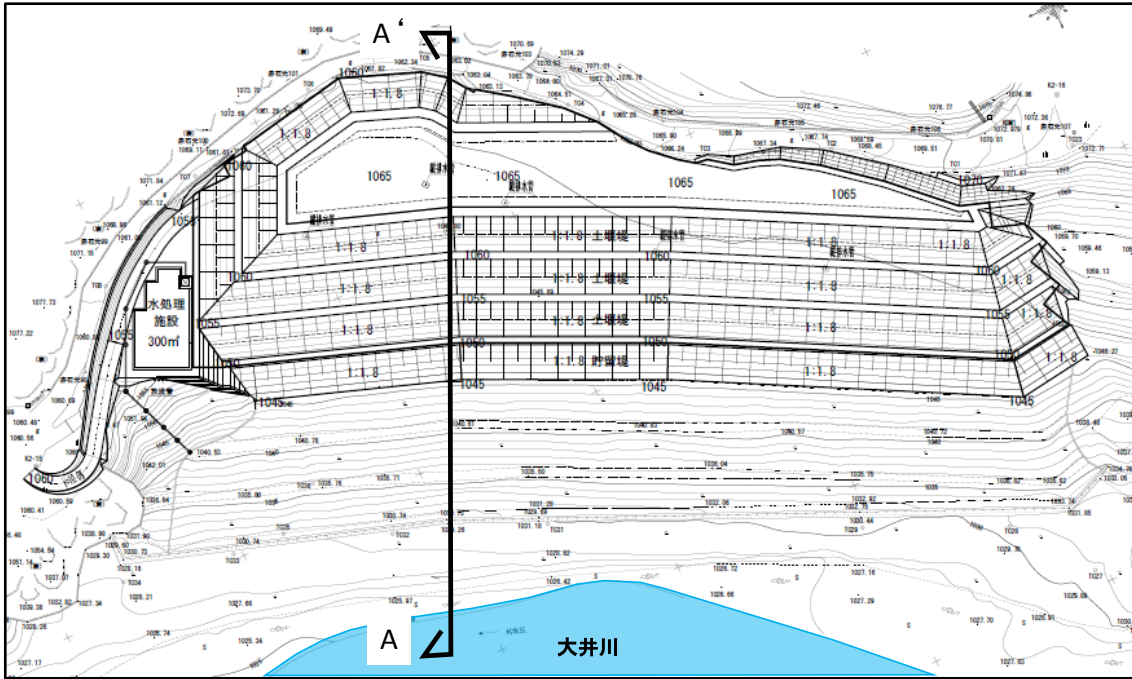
藤島沢付近の発生土置き場（遮水型）計画平面図
